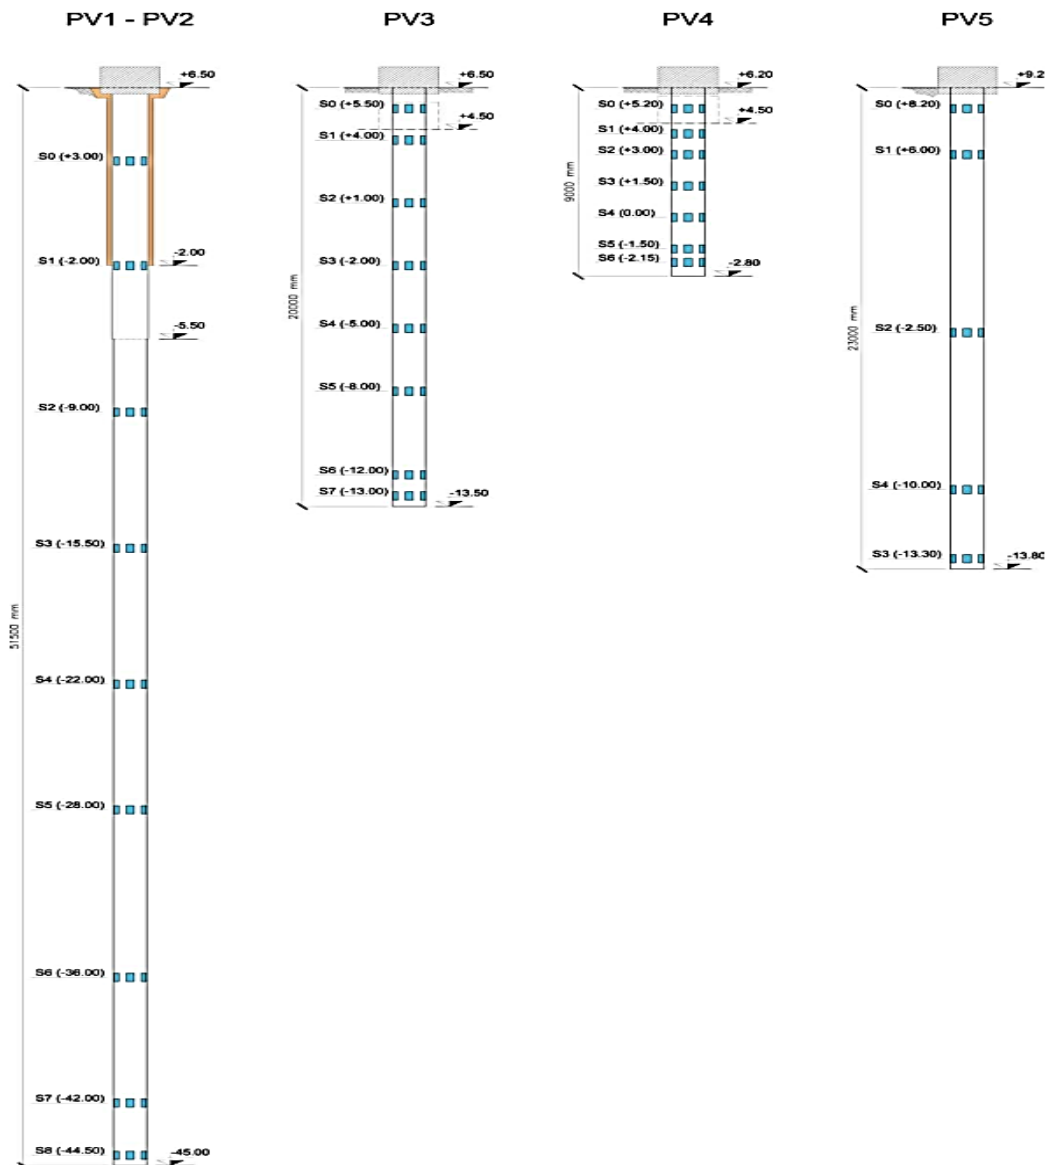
Disposition des sections extensiométriques pour les pieux d'essais PV1, PV2, PV3, PV4 et PV5. [16]
